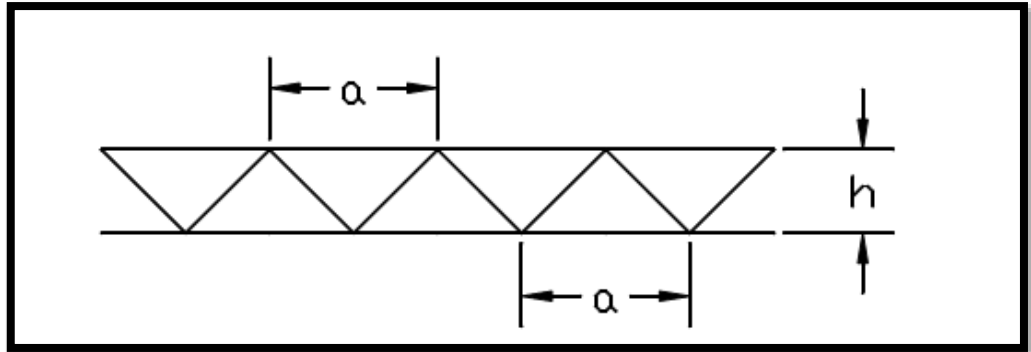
Vista en Planta de la Pirámide de Base Cuadrada
